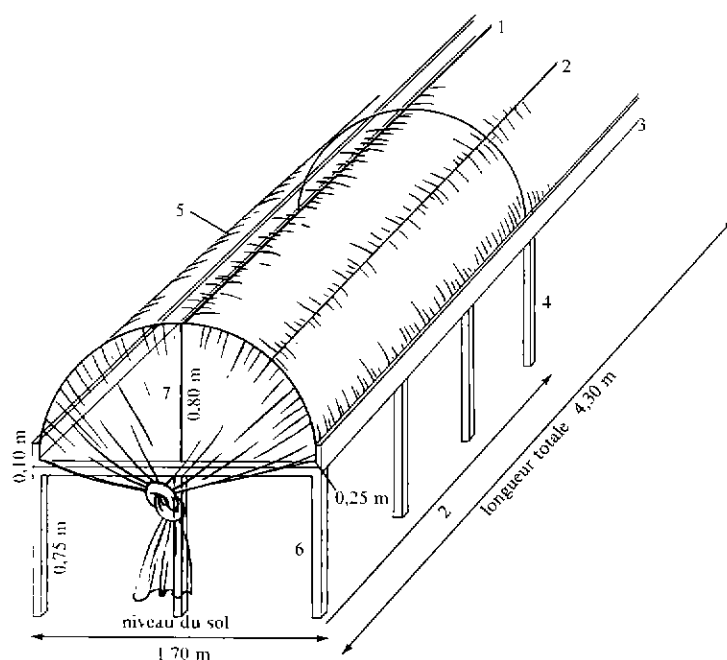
Tunnel sur table à poutres en béton — (Tunnel on table with concrete legs — Tunnel sobre mesa con travesaños de hormigón).
